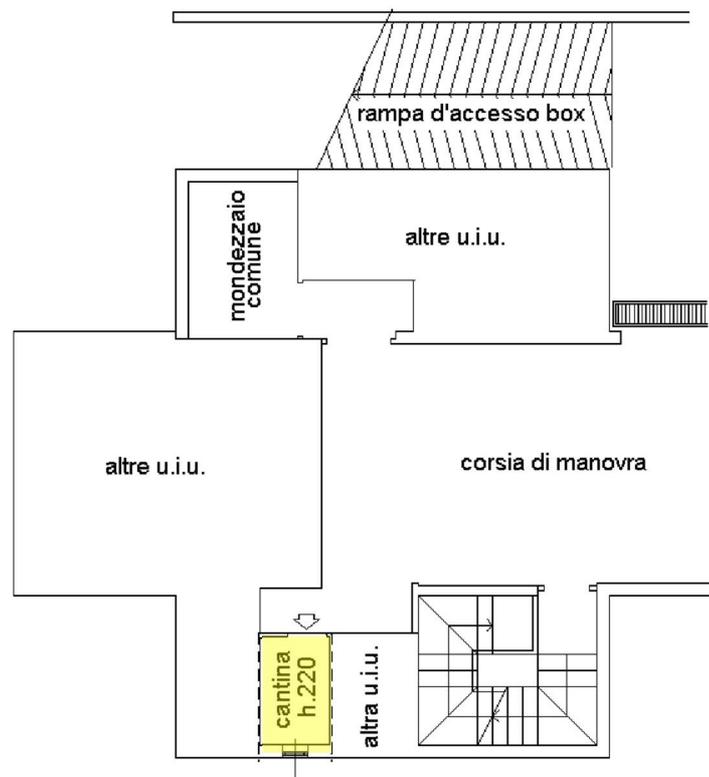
A - Planimetria dell'appartamento e cantina (evidenziato in giallo) sito in via Frosinone n. 30, Milano (MI).
